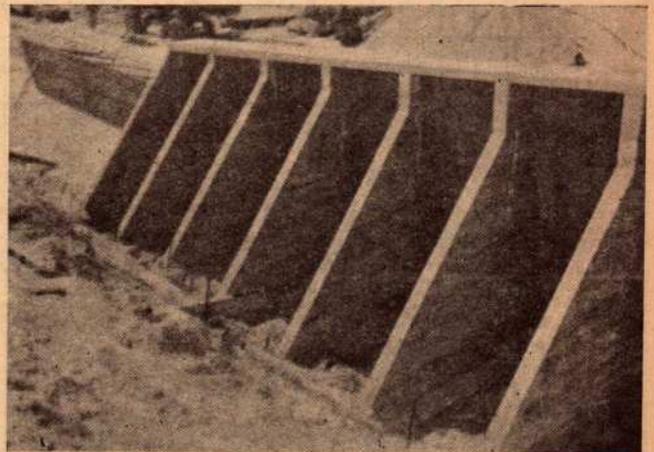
Trecho já concretado dos muros de arrimo das carreiras
